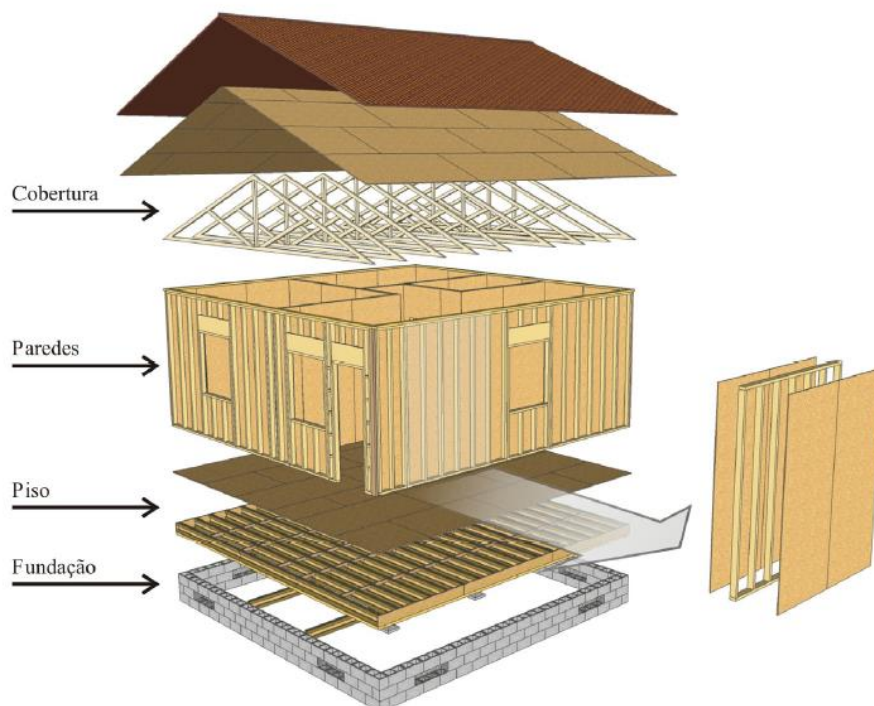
Subsistemas (elementos) estruturais do *Light Wood Frame
